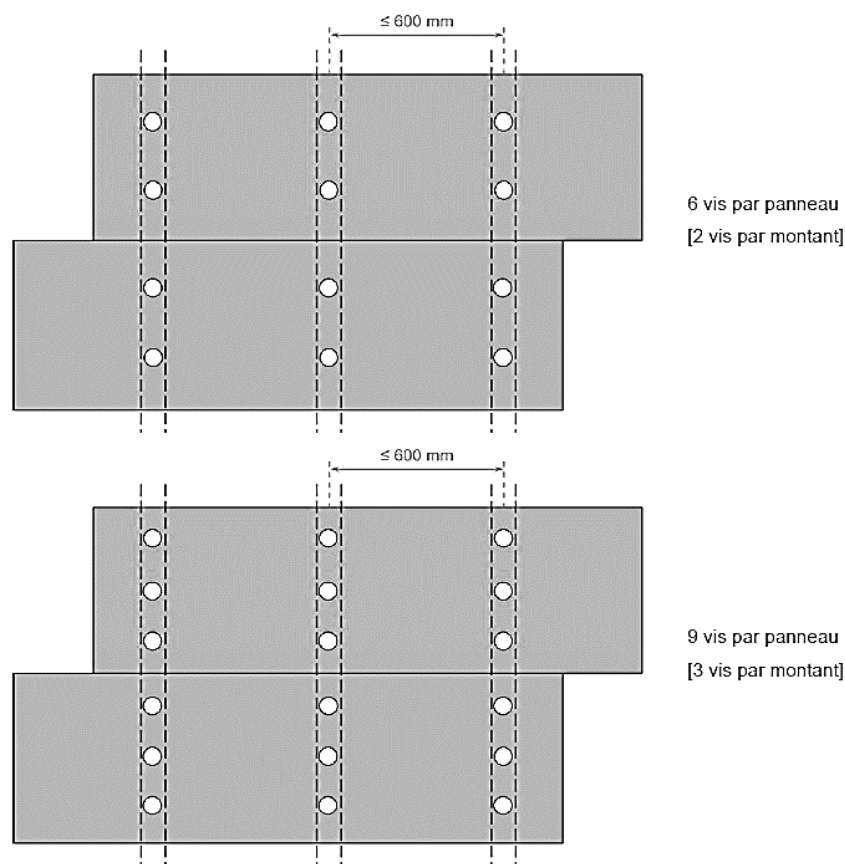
Plan de fixation des panneaux isolants en partie courante (exemples).
